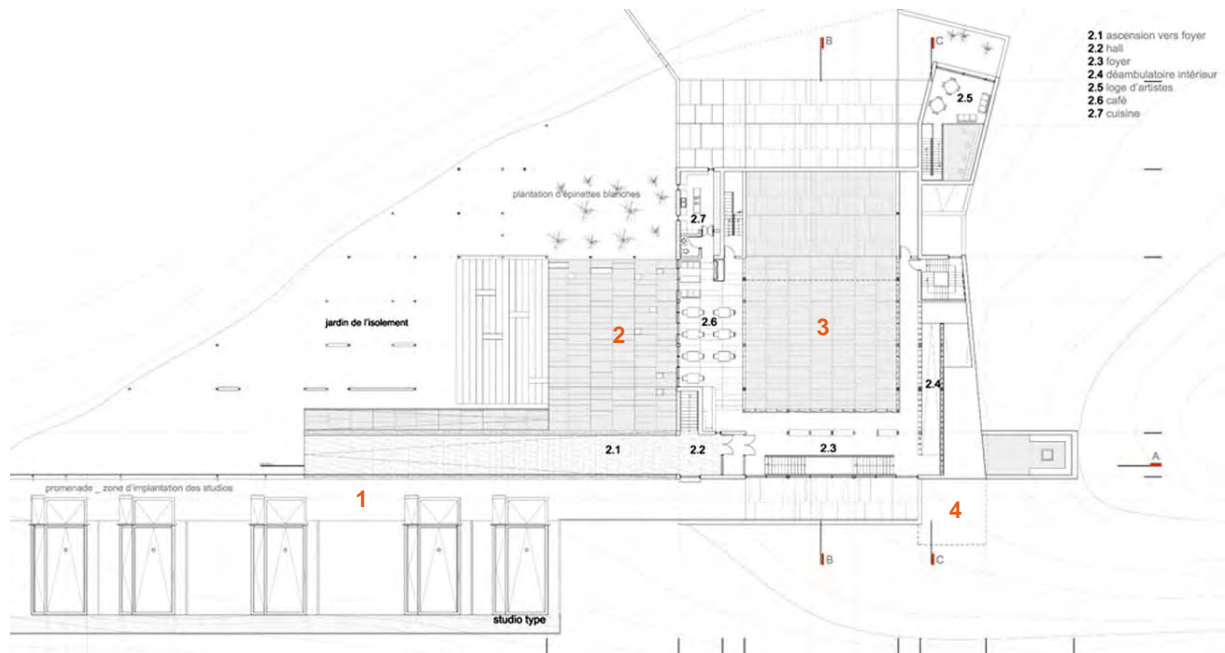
Plan niveau. 1, niveau de l'accès au café
